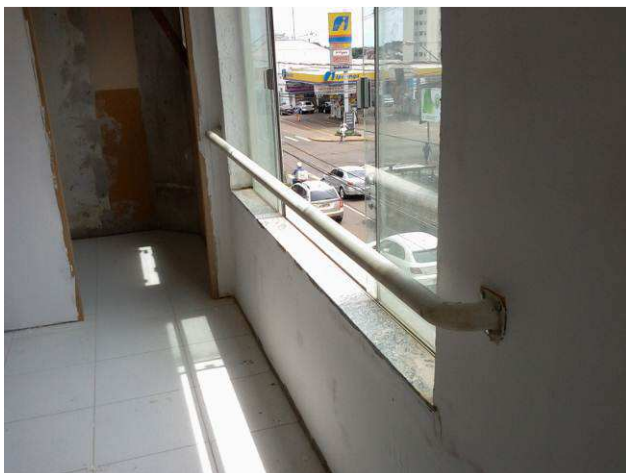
C: barra de proteção (corrimão) das janelas, instalada em janela do primeiro pavimento
